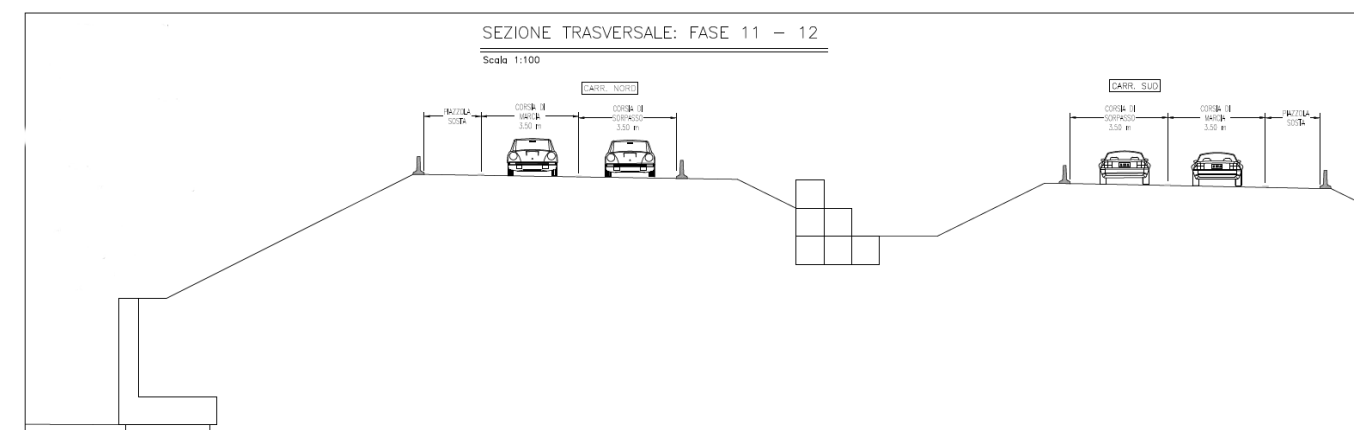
Sezione trasversale: Fasi 11 e 12
